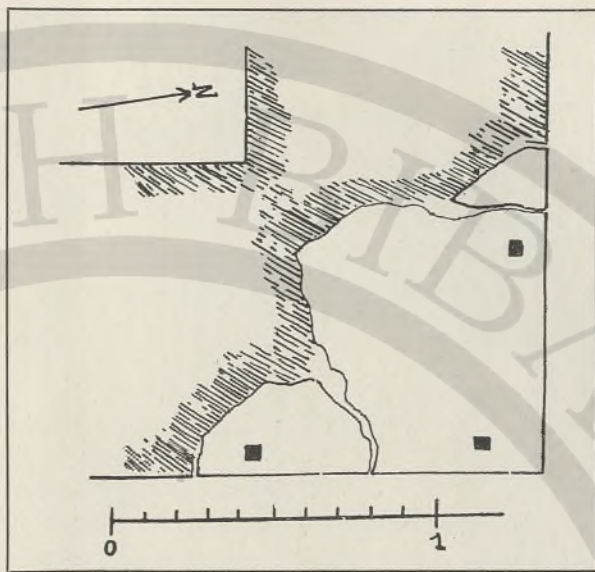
BASAMENTO DEL PILASTRO ANGOLARE DEL CORRIDOIO 73
